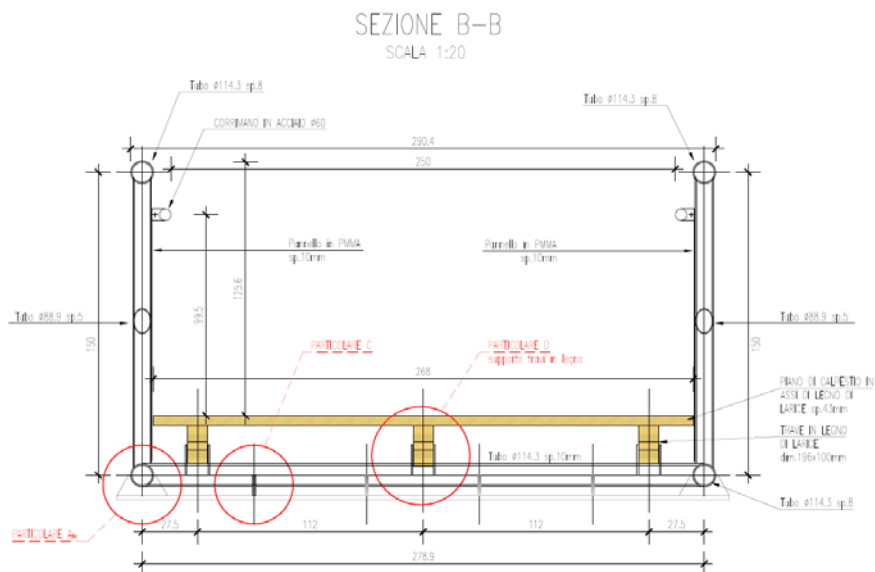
Sezione trasversale passerella ciclopedonale
